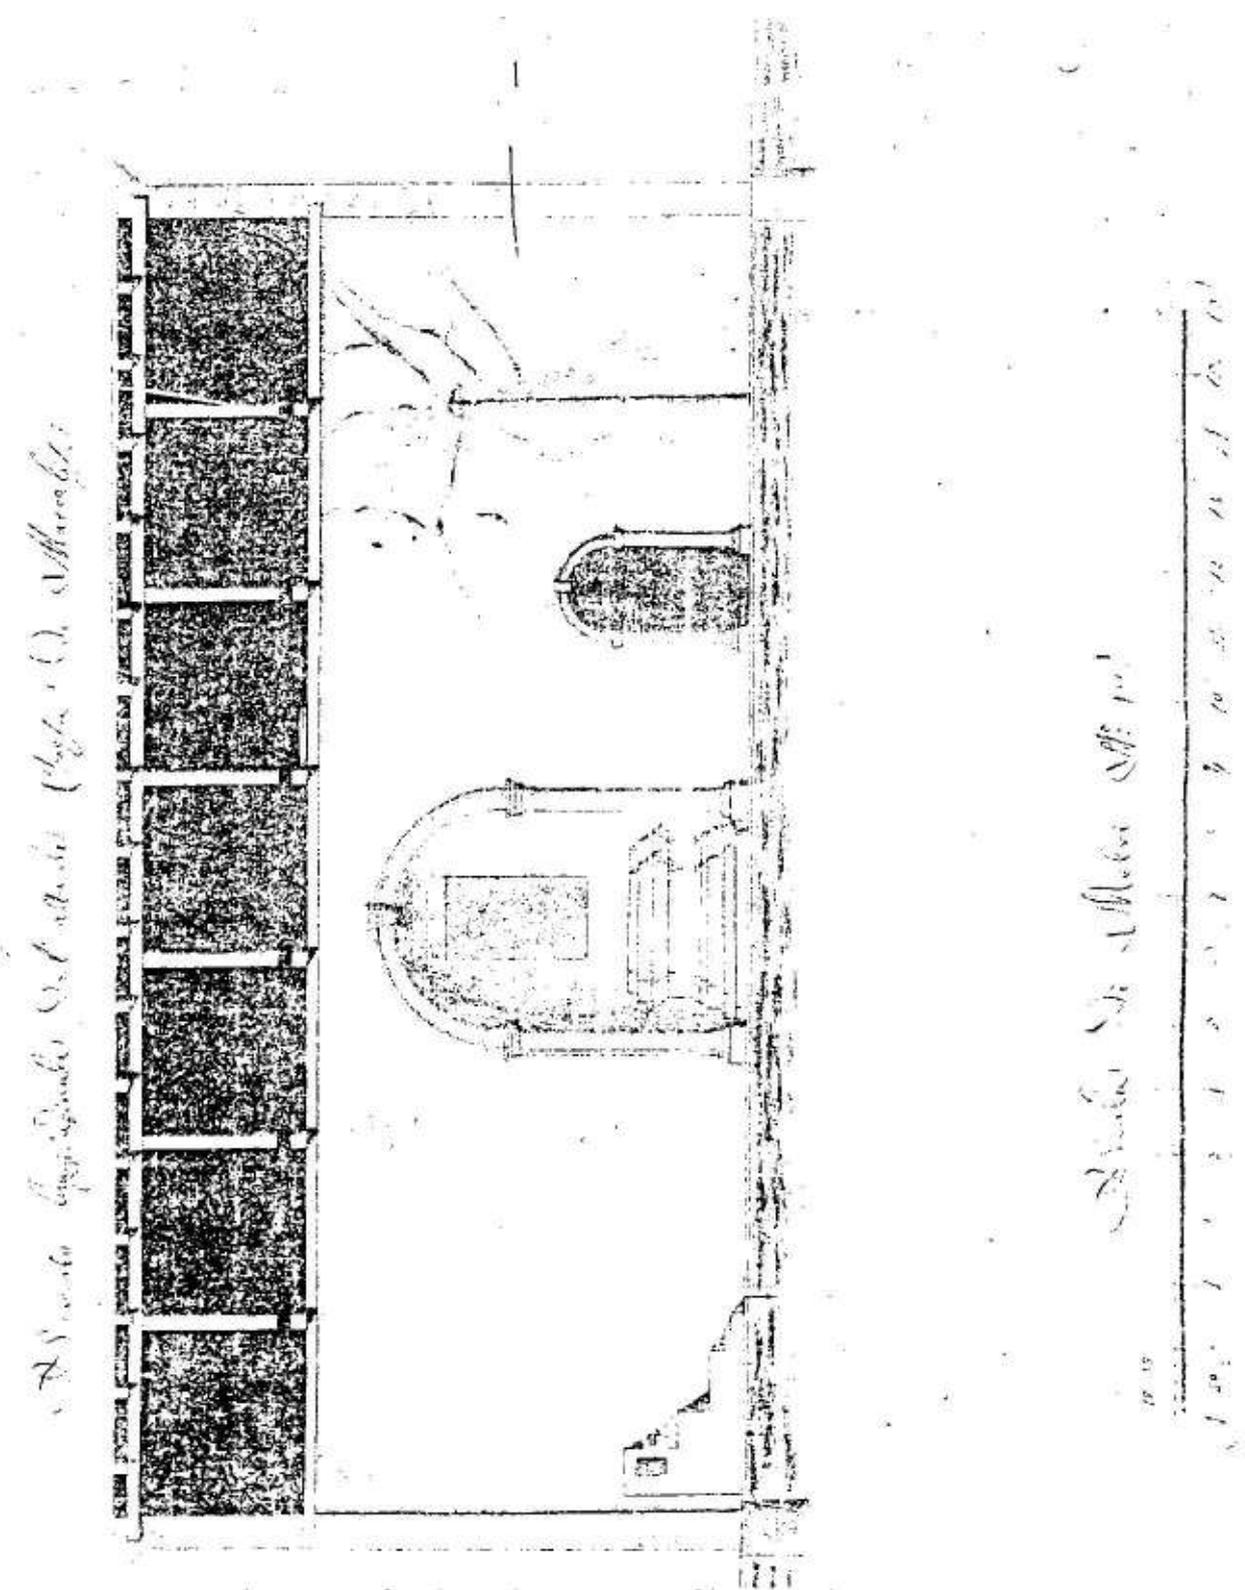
Progetto dell'ing. Gaetano Bergamaschi (1819): sezione longitudinale della chiesa allora esistente; da notare la vistosa puntellatura della parete.
